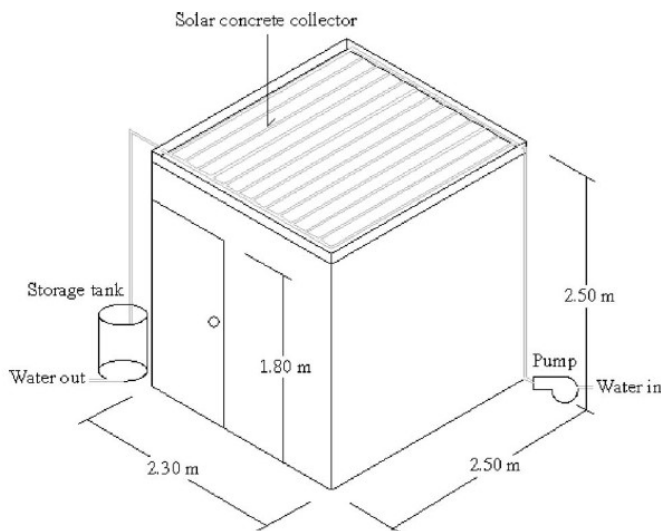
\_ Dimensione sala di prova collettore integrato in copertura [23]
